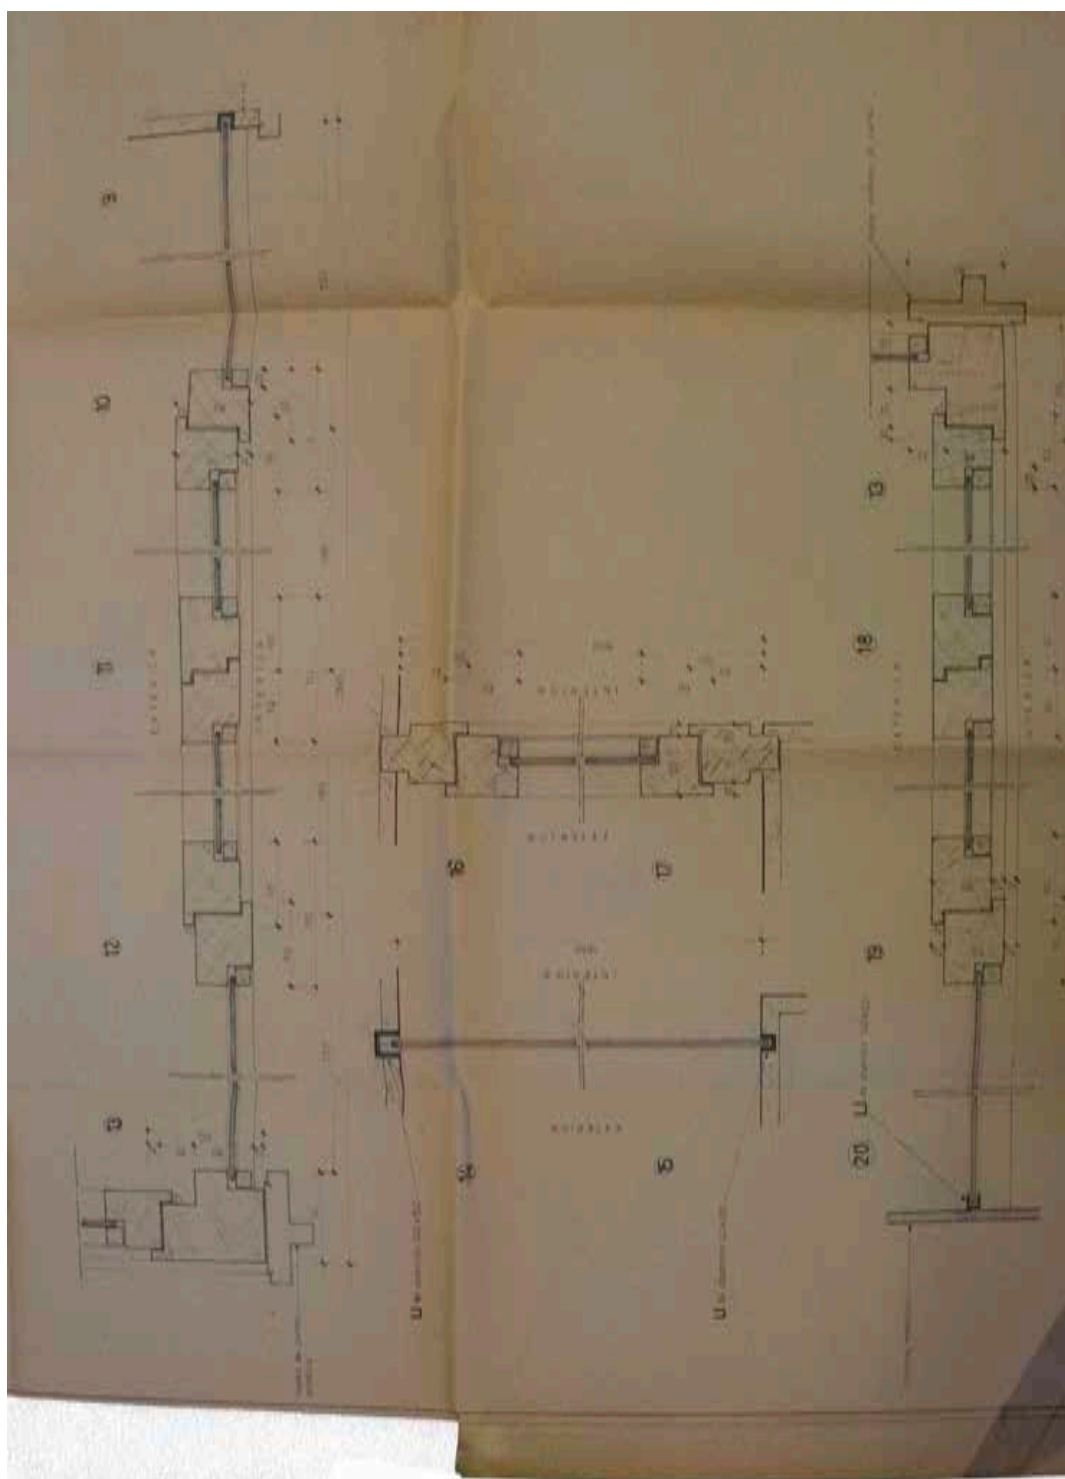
Detalles de carpintería del proyecto original del Edificio Escalonado Babilonia. Arquitecto: Antonio Bonet Castellana.. Fecha julio de 1965. Fuente: Archivo Municipal de Cartagena
